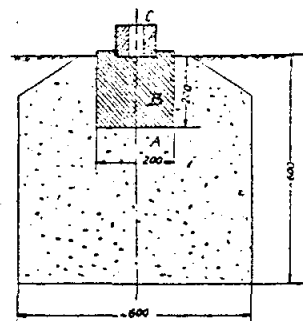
Cimentación para el dispositivo de percusión; corte vertical. Dimensiones en mm.
